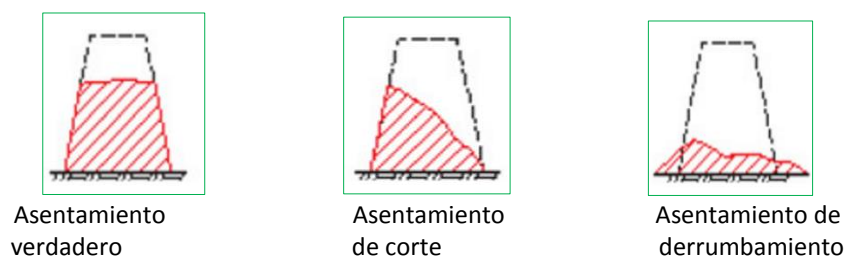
Tipos de asentamiento (Neville y Brooks)
